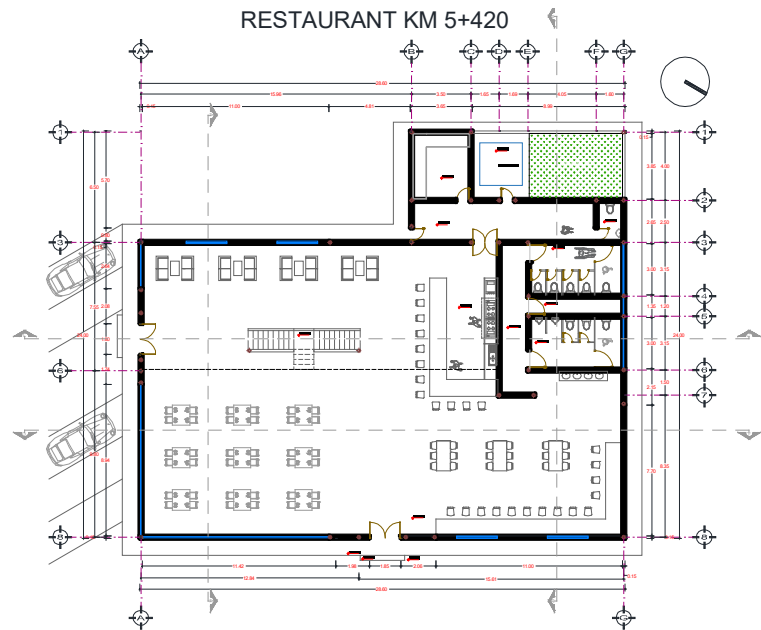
Propuesta Restaurante, Planta arquitectónica (Anexos Plano: 1-ARO-REST-PB)
